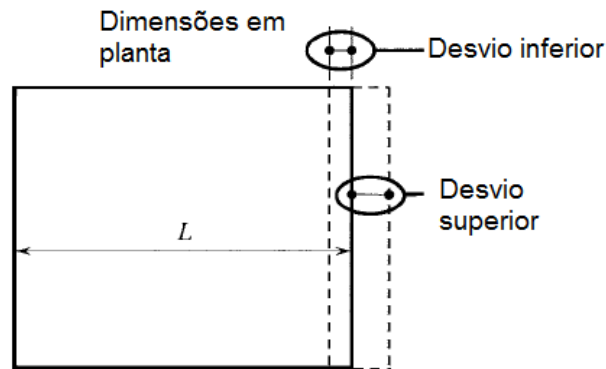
Ilustração das dimensões para fundações uniformemente betonadas contra o terreno (adaptado da Fig. R3.5.2 [11]).
